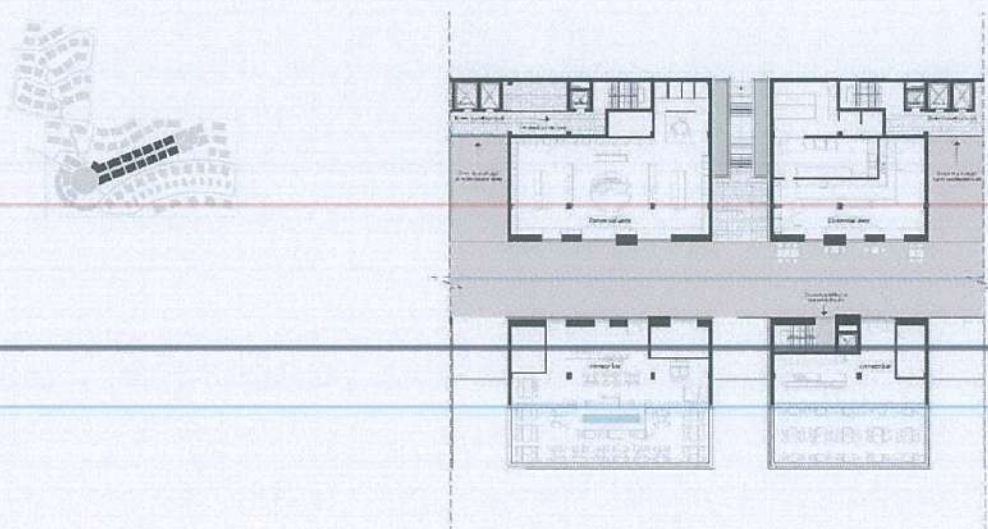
Sunset Avenue: Planimetria e shërbimeve.
